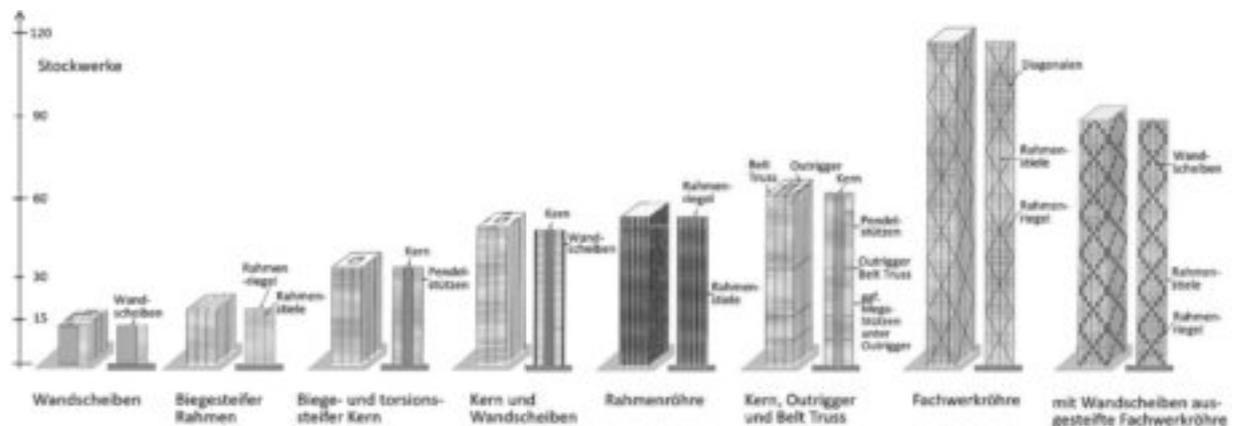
Gebräuchliche Aussteifungssysteme für Stahl und Stahlbetongebäude und zugehörige, sehr grobe Höhenangaben nach [2]
